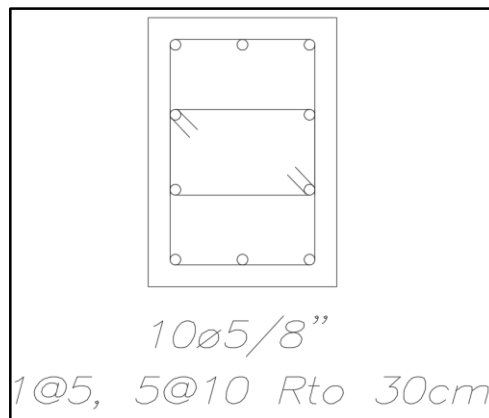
Detalle del acero de refuerzo de la columna 35x50cm
